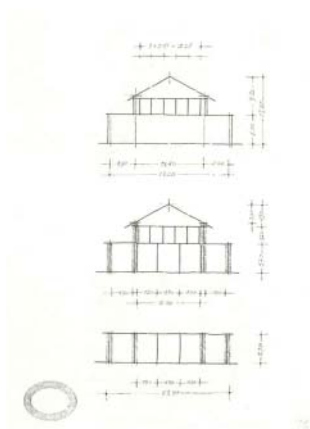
Sezione e pianta della chiesa di Vaals.
